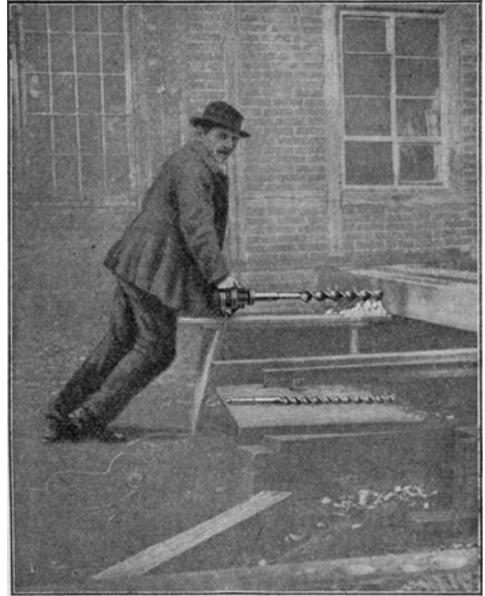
Horizontalbohrung mit elektrisch betriebener Bohrmaschine der A. E. G.
